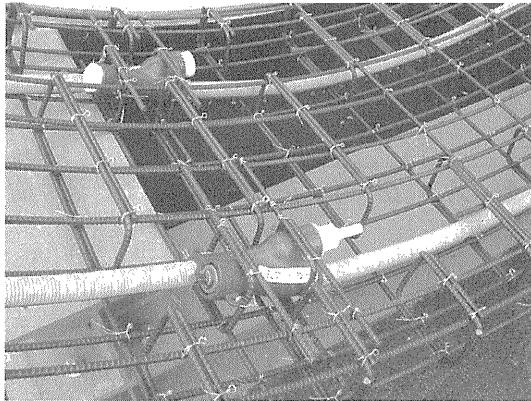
Xアンカー、鉄筋およびポリエチレンシースの配置
